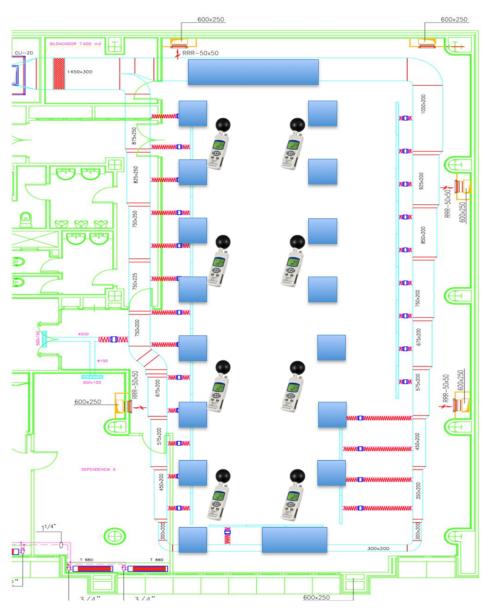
Plano de planta donde se muestran los puntos de medida.
